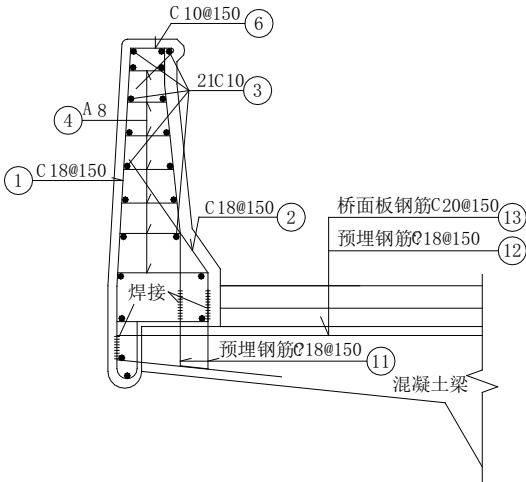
防撞护栏与基础桥面板构造钢筋图(单位:mm)
